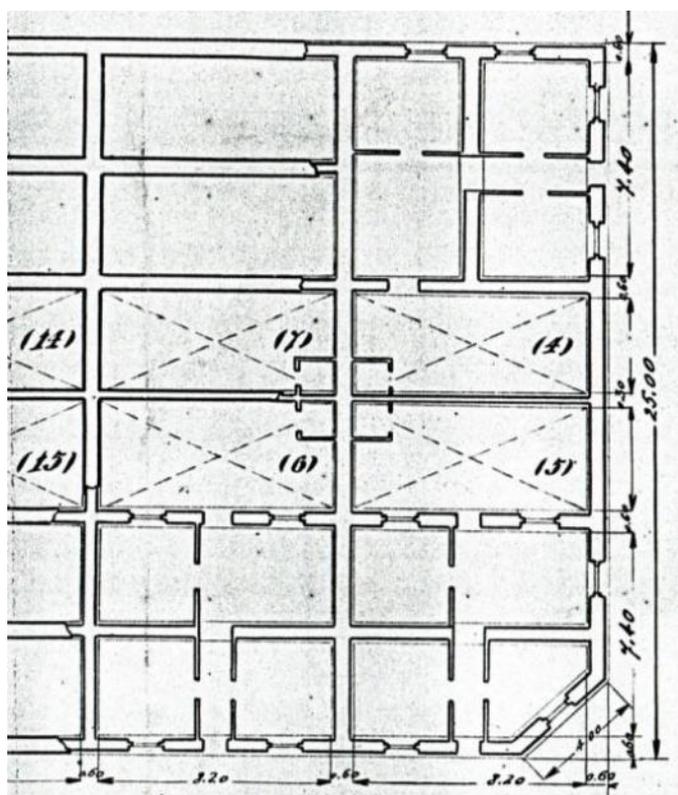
Imagen de la distribución interior de las viviendas extraída del plano de planta.
